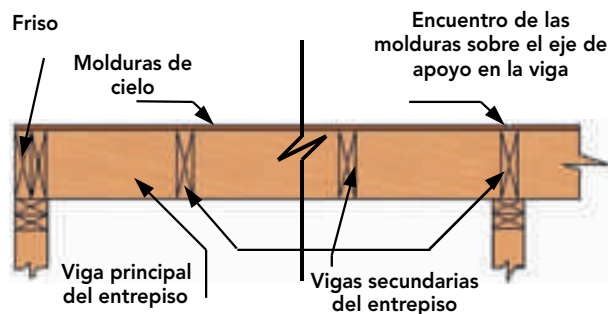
Corte de entrapiso que muestra las molduras apoyadas y fijadas sobre el envigado, quedando las vigas a la vista. Sobre éstas se debe considerar la base para la solución de pavimento y aislación acústica.
